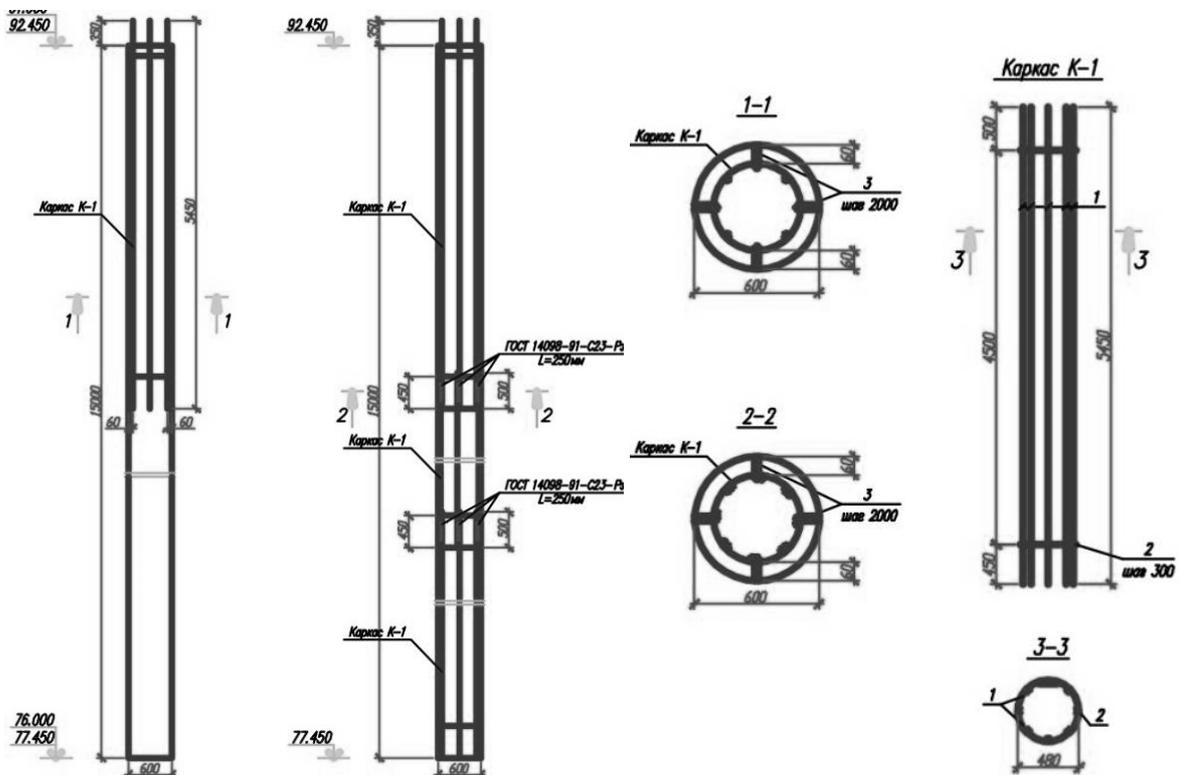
Конструкции: буронабивных свай БС-1 (а) и БС-2 (б); в – поперечные сечения 1-1 и 2-2 по БС-1 и БС-2; г – секции арматурного каркаса К-1 для БС-1 и БС-2
